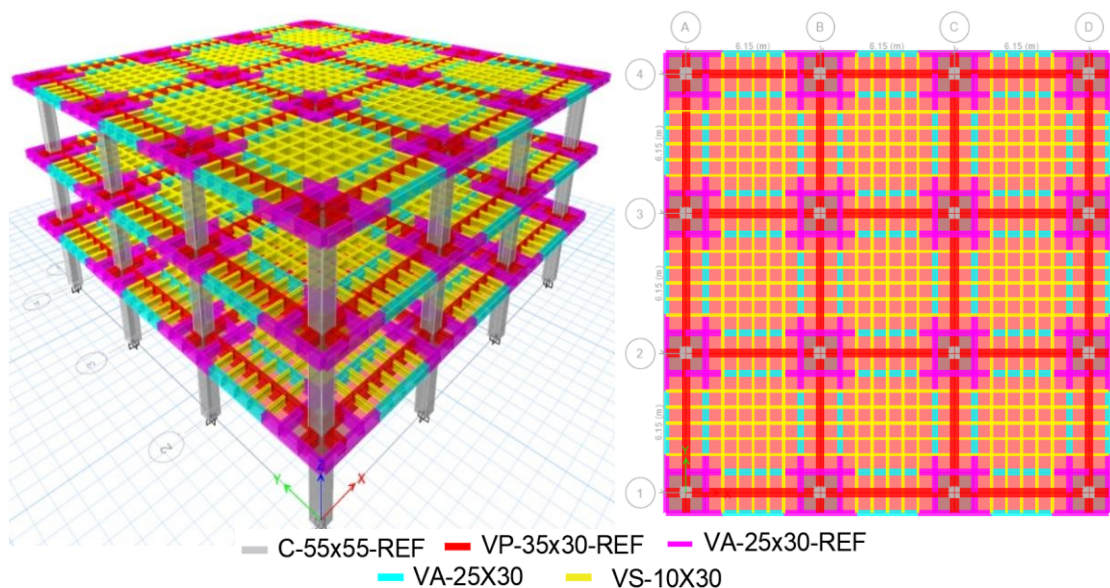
Modelo estructural de la estructura con sistemas de refuerzos.
